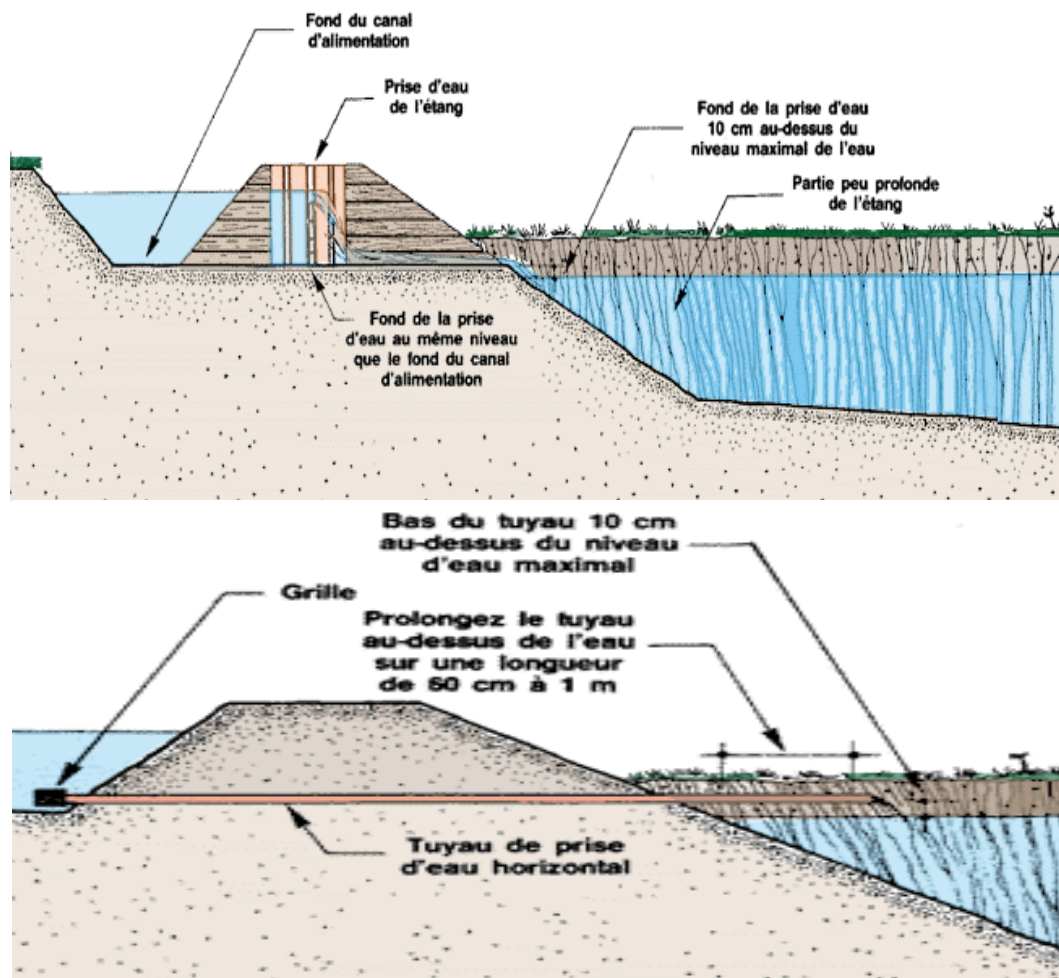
Conception des ouvrages de prise d'eau (FAO, 2006)
